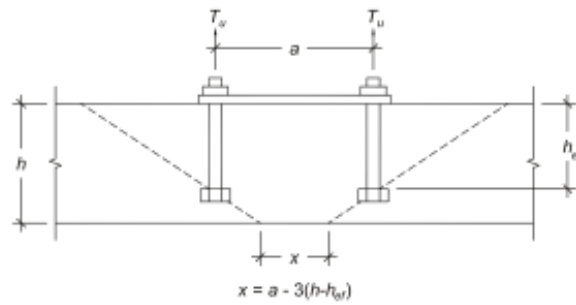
Cono de quebrantamiento del hormigón para el conjunto de barras.
